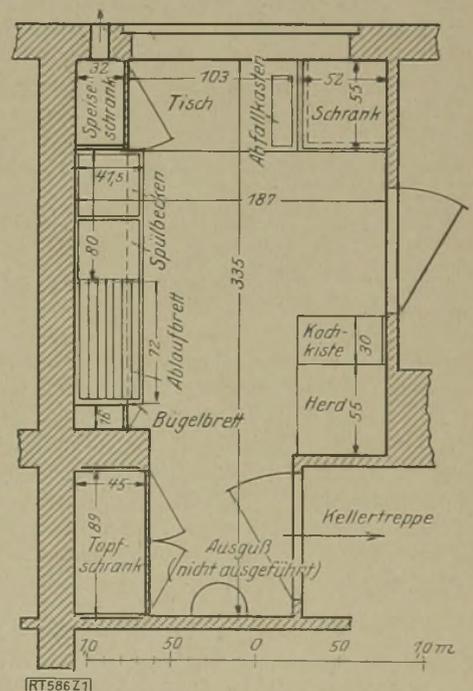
Grundriß der Frankfurter Küche (eingebaut). Architekten: Stadtbaurat May und Frau Schütte-Lihotzky
